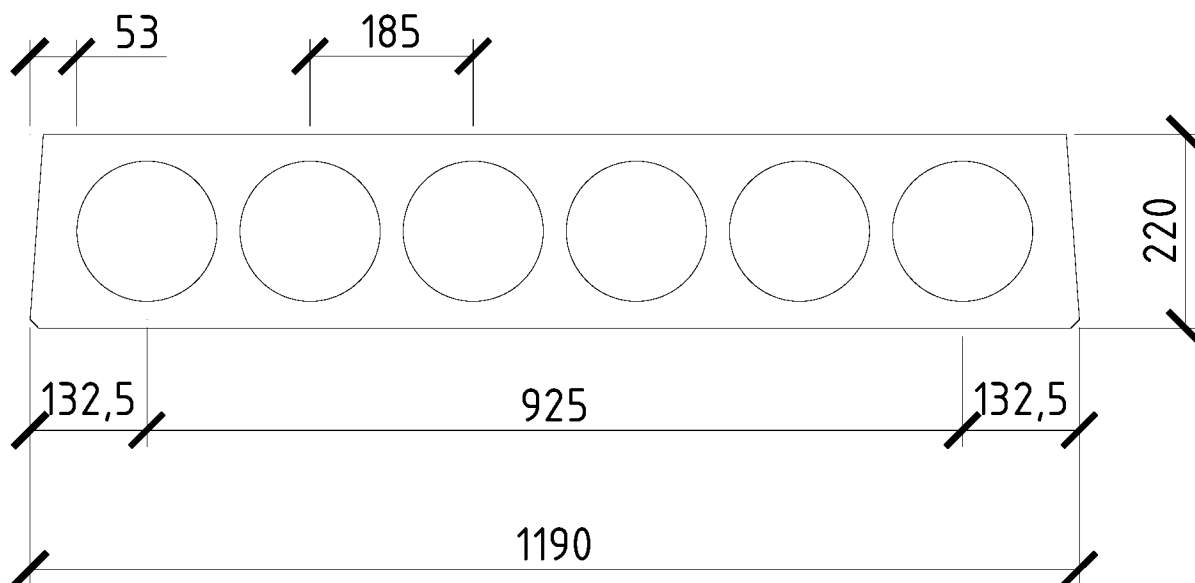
Переріз круглопустотної залізобетонної плити, шириною 1200 мм.
